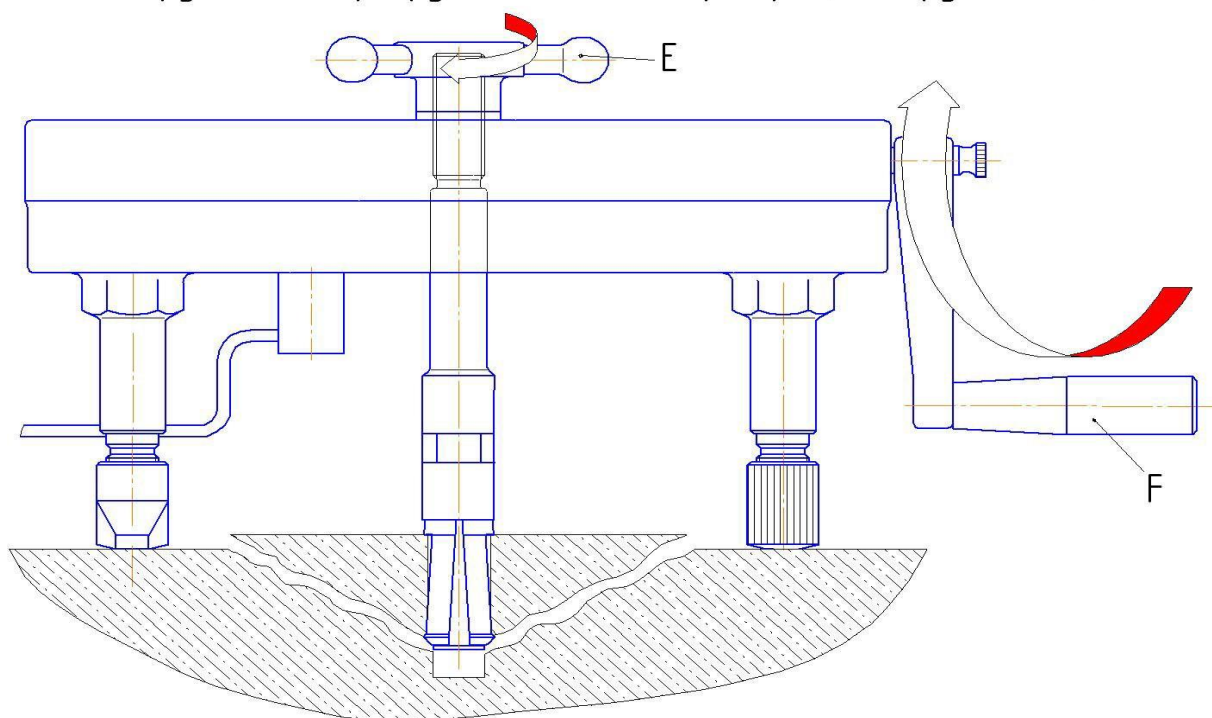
Подготовка и установка прибора «ОНИКС-ОС» для испытаний
